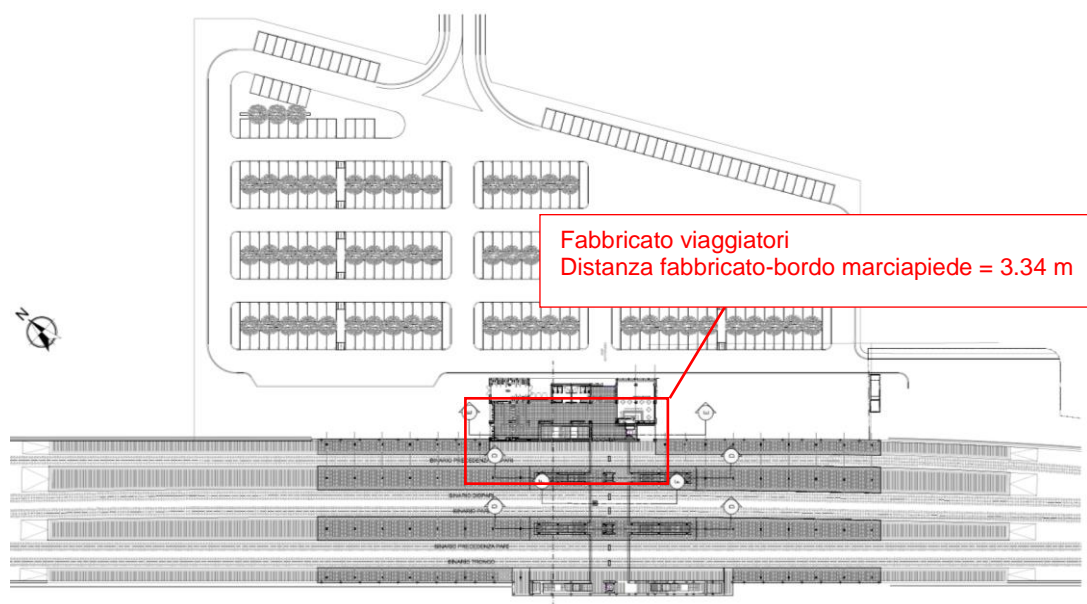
Planimetria d'insieme della stazione e parcheggio di Vigna di Valle
